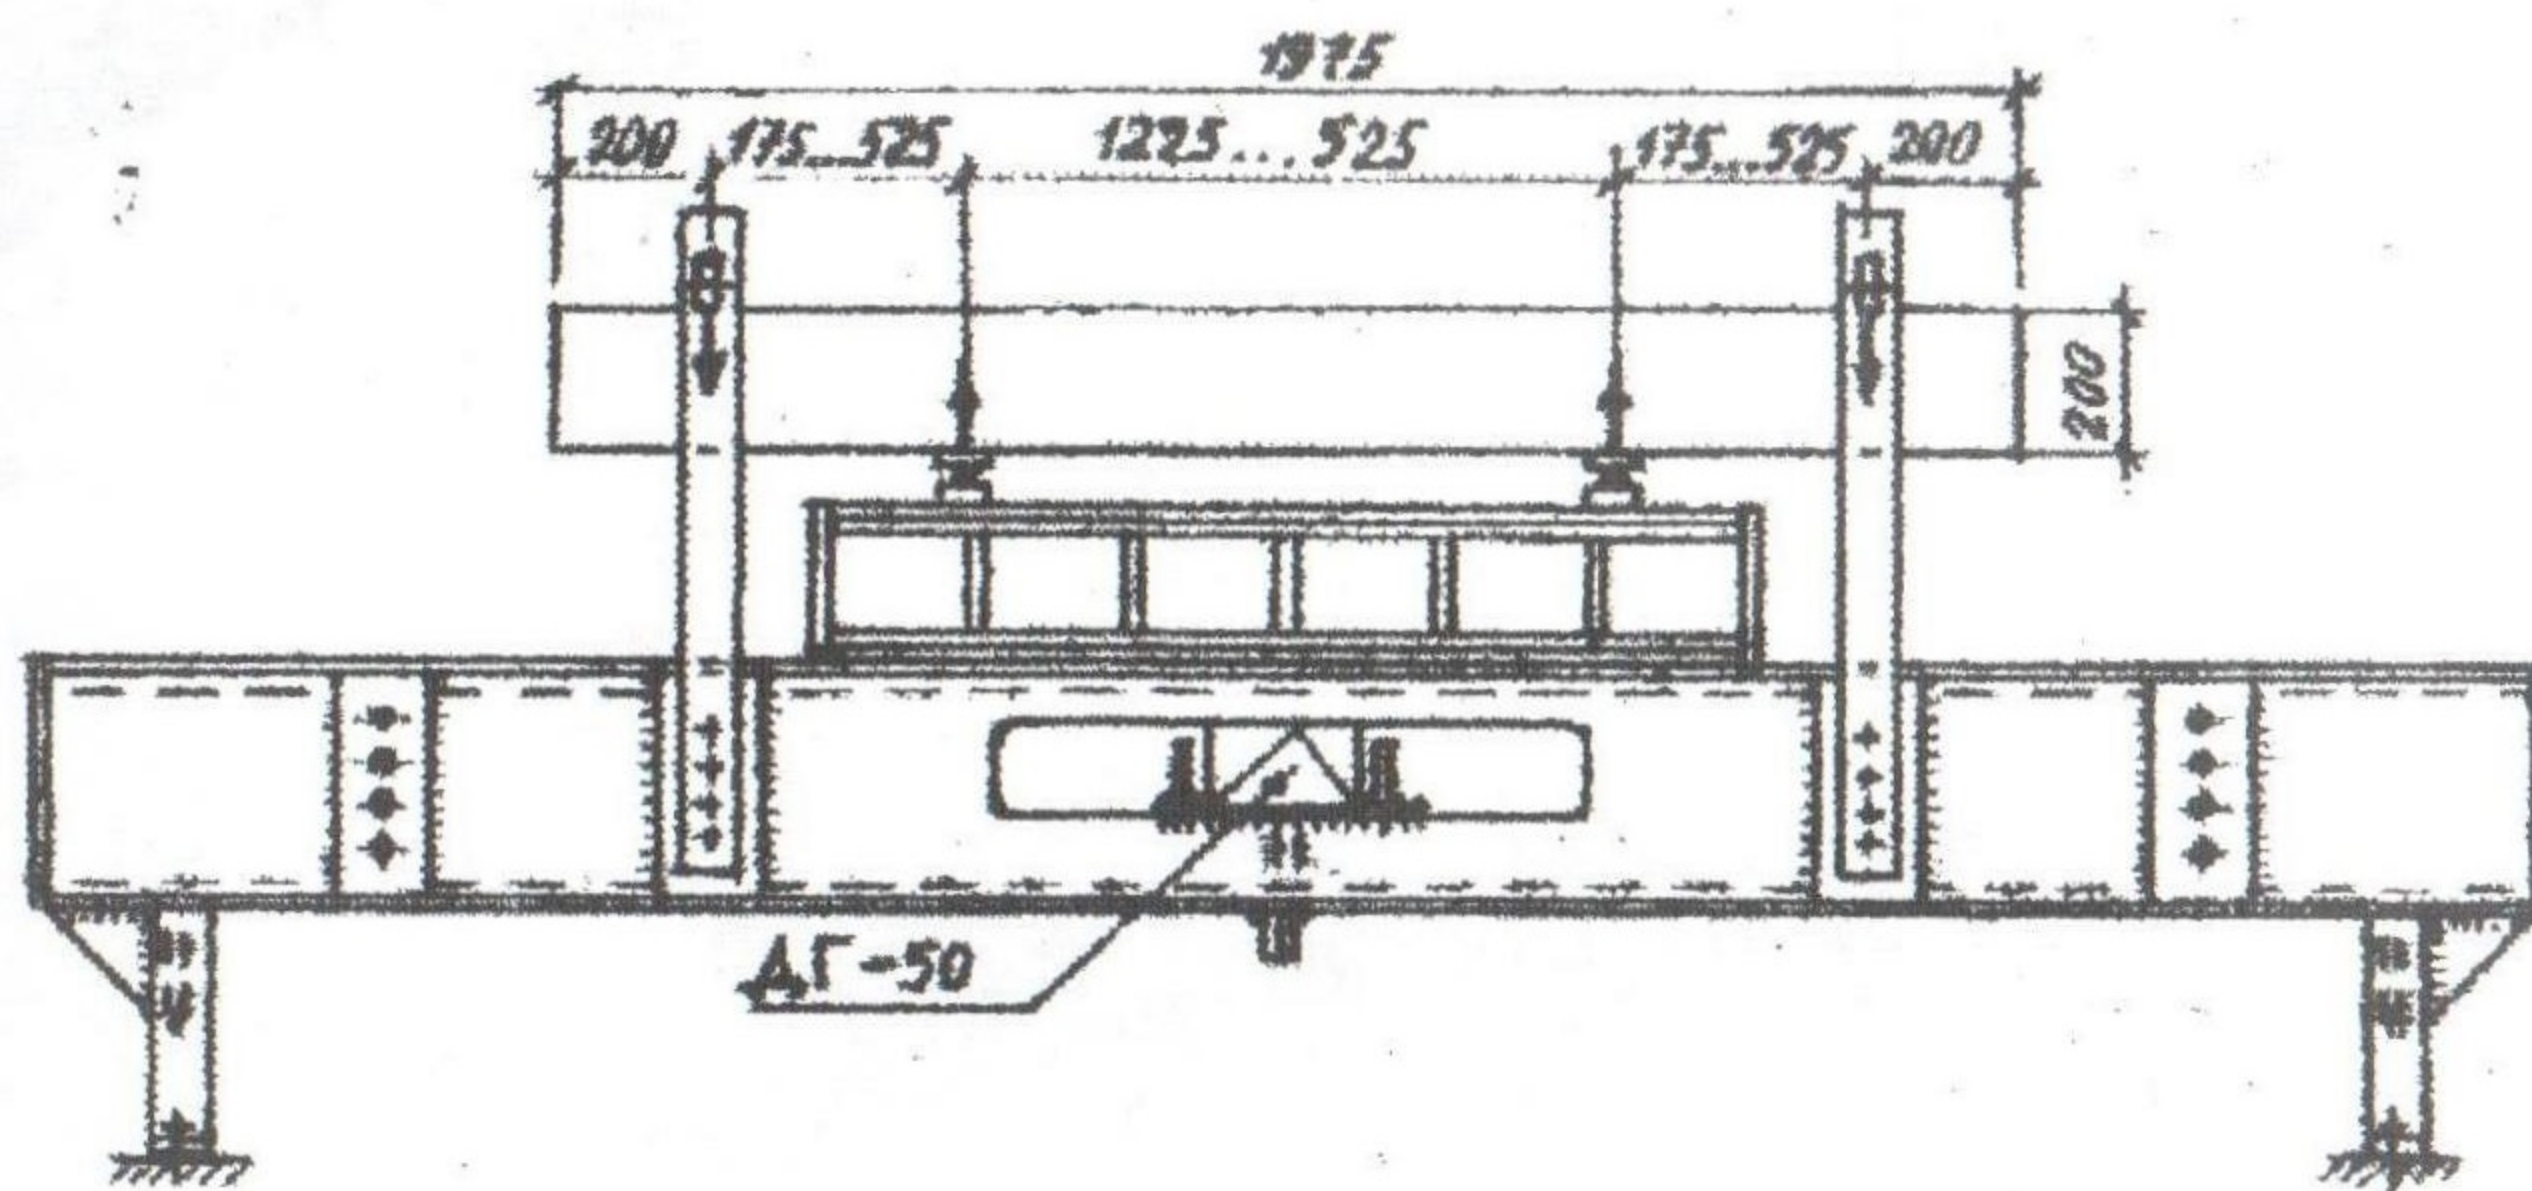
Силовая установка для испытания на поперечный изгиб опытной балки
